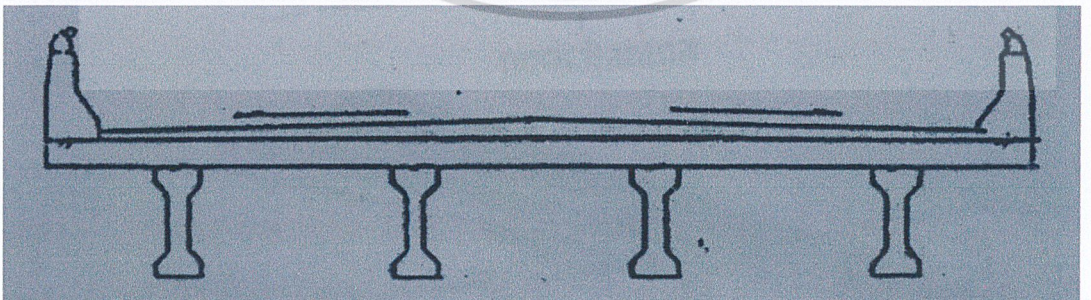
REINFORCED CONCRETE SLAB TYPE
